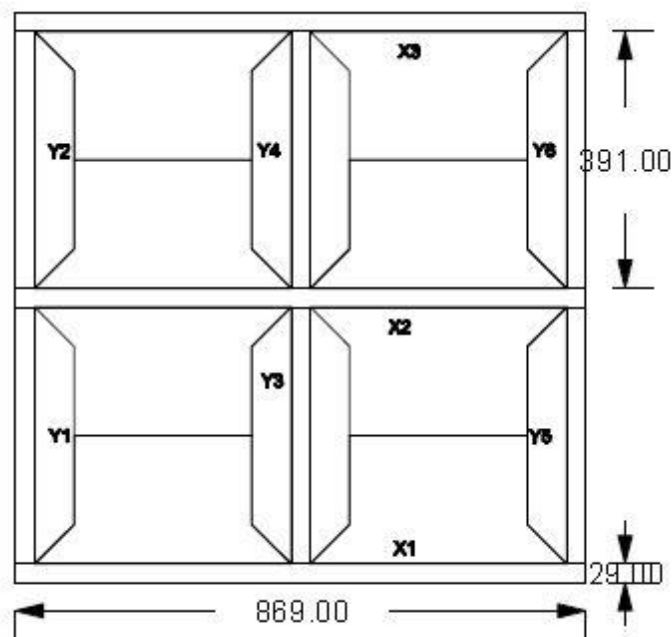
Pianta piano tipo: aree di solaio gravanti sui muri
